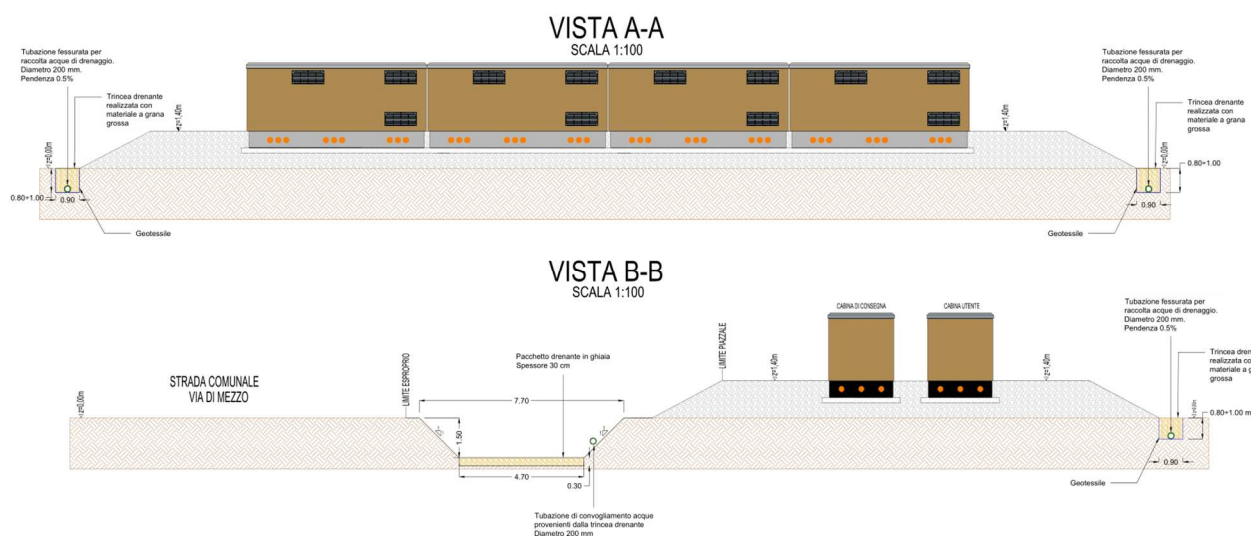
Sezioni della sistemazione idraulica di progetto delle cabine di consegna
